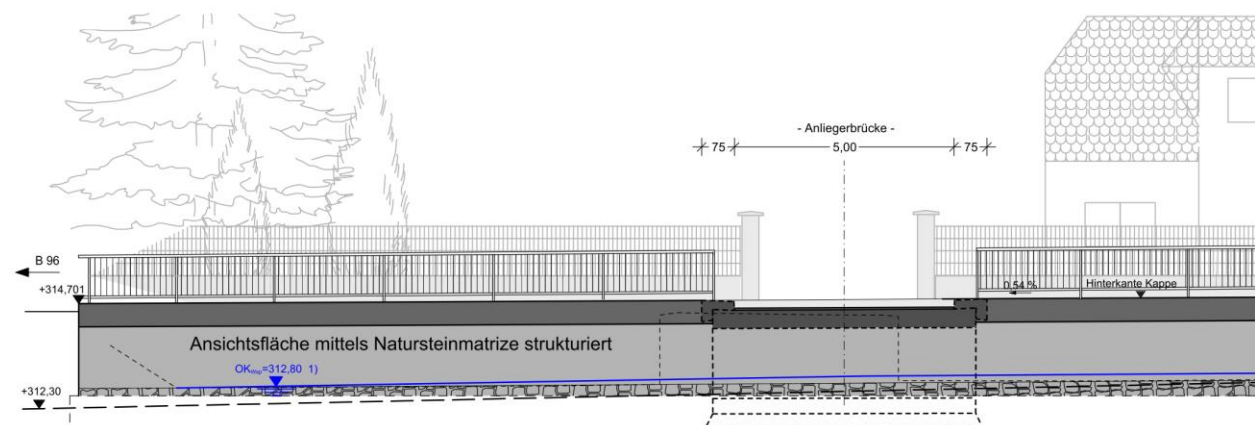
Bauwerksansicht Ufermauer mit Anliegerbrücke
